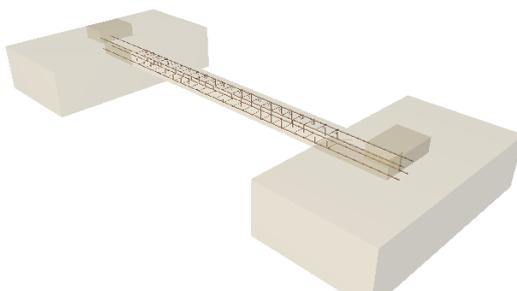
Viga de atado. Fuente: CYPE 2017
